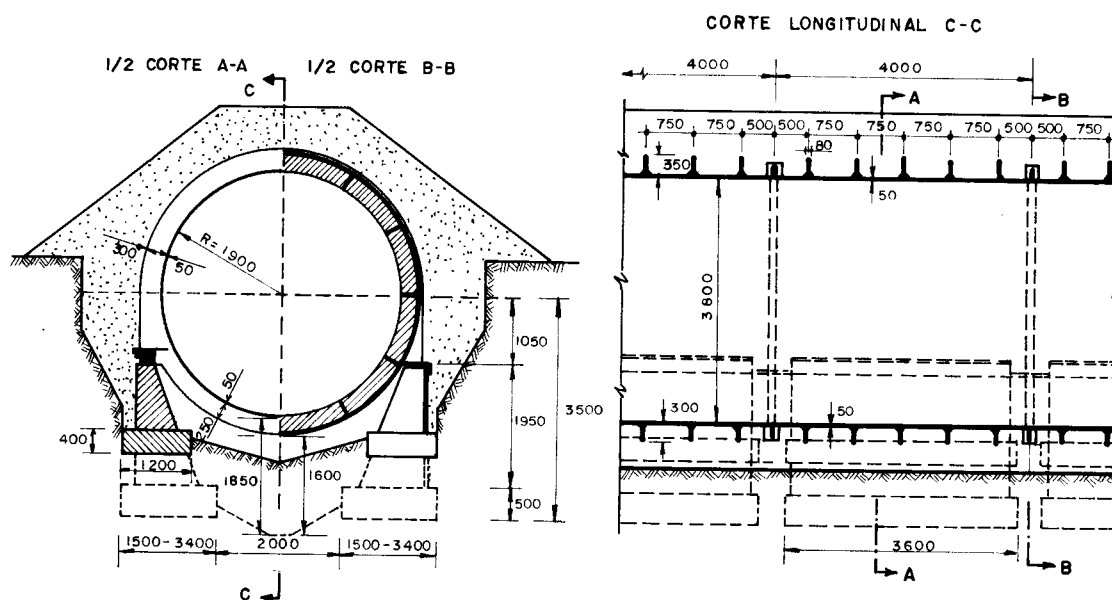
Estudo de conduto forçado em argamassa armada¹⁰⁸
